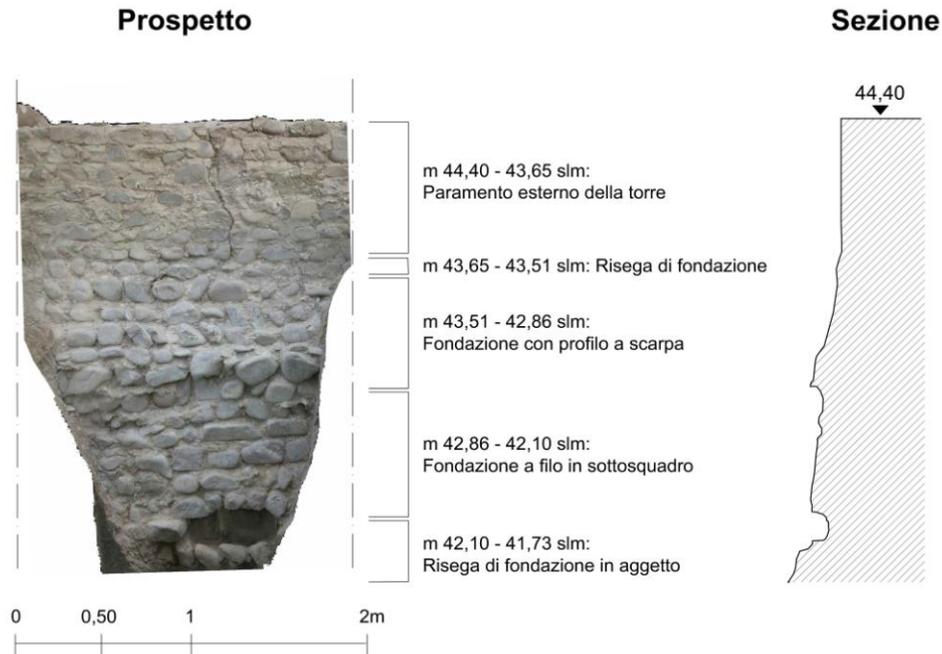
Saggio nell'angolo NE della torre: prospetto e sezione delle murature messe in luce (rilievo ed elaborazione A. Pansini).
